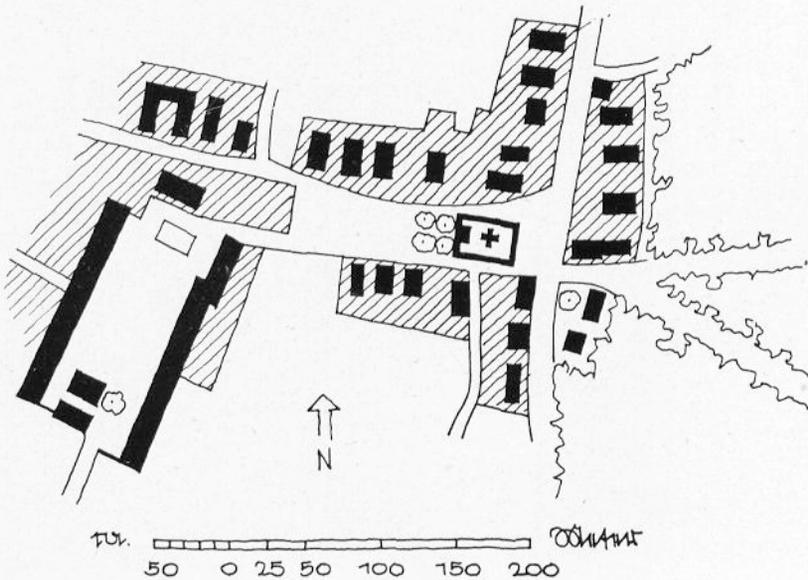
Lageplan des Dorfbangers in Steinfurt
